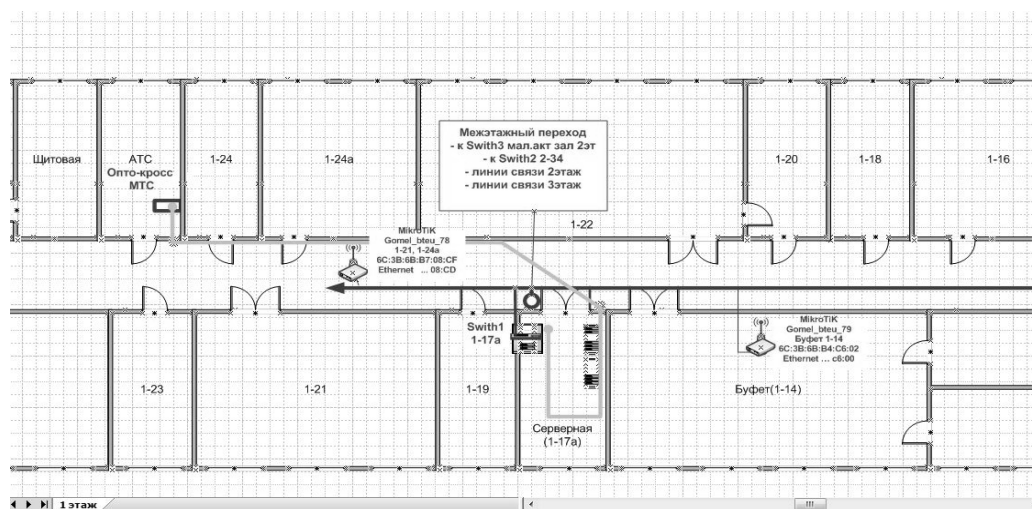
Часть детальной схемы беспроводной сети WiFi-bteu 1 этаж
